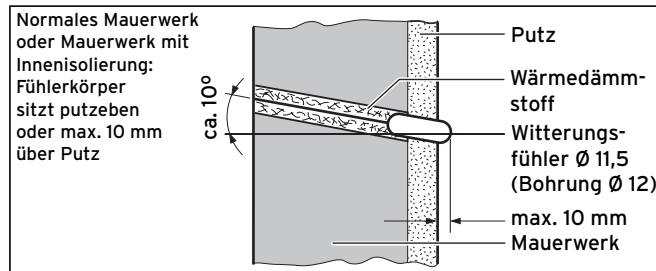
Normales Mauerwerk oder Mauerwerk mit Innenisolierung
